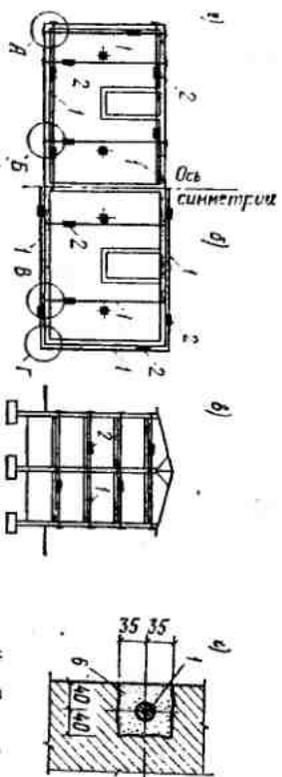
Крепление стен металлических тяжами в уровне перекрытия
